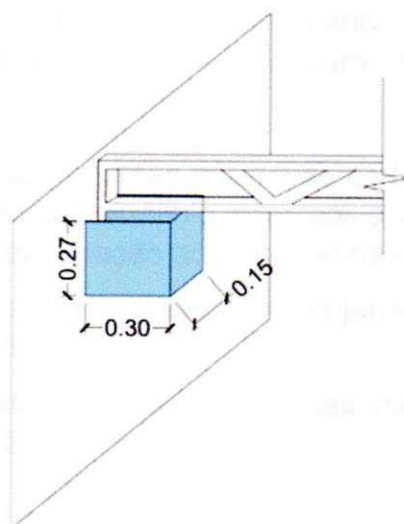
Ilustração para orientação do fechamento do apoio das tesouras
